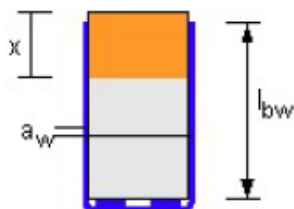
Esquema de posicionamento de laminados aderidos externamente (A_f) com manta de confinamento transversal (a_w)- Vão 54-42 - Pórtico 12
